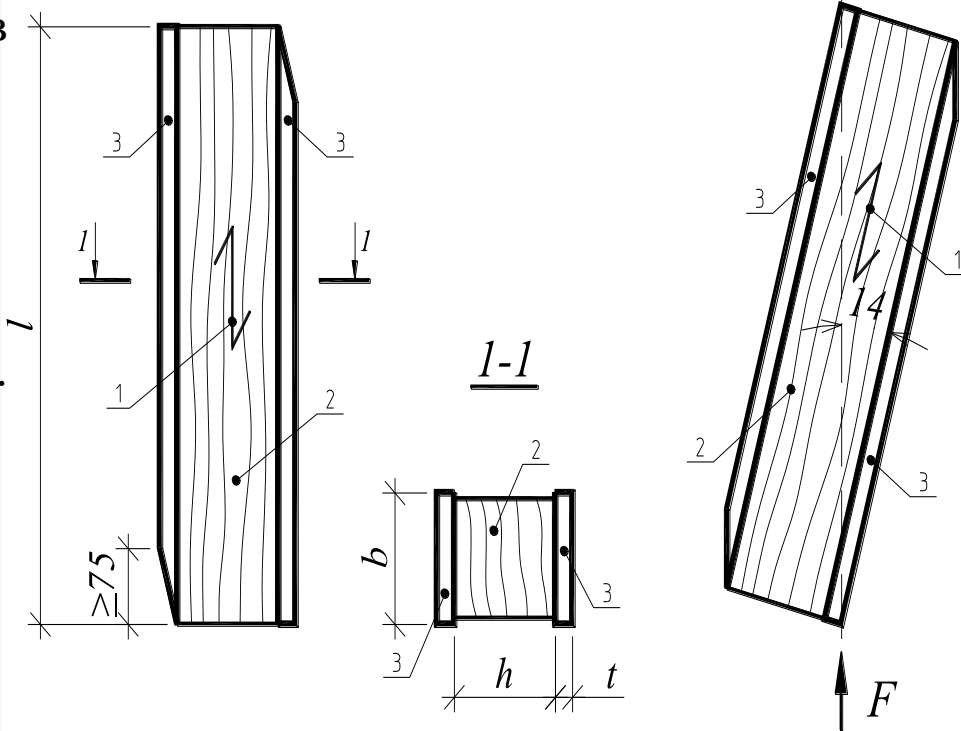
Испытываемый образец и схема испытаний: 1 - направление волокон; 2 – испытываемый образец; 3 – стальная пластина
